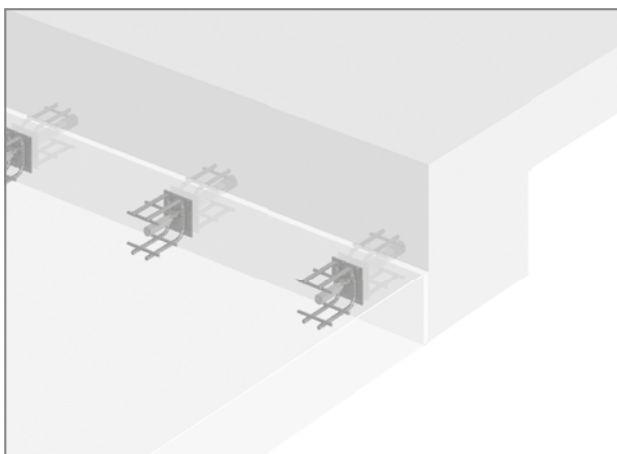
Schöck Dorn type SLD : liaison dalle-poutre
